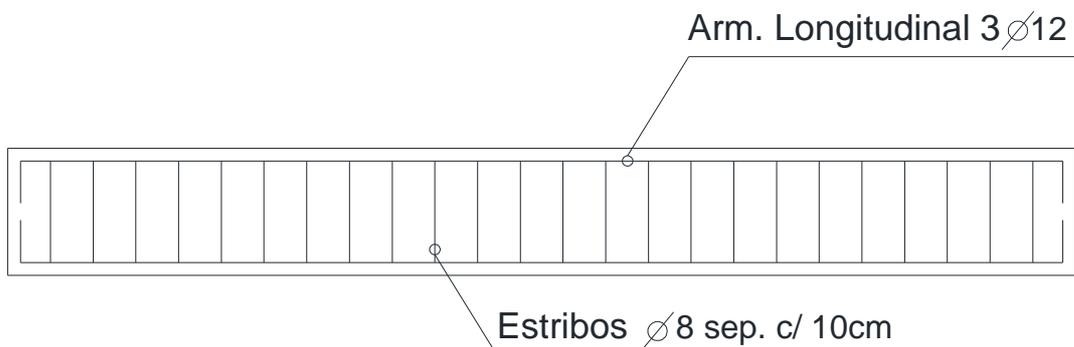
Detalle de armado de las vigas de apoyo.
